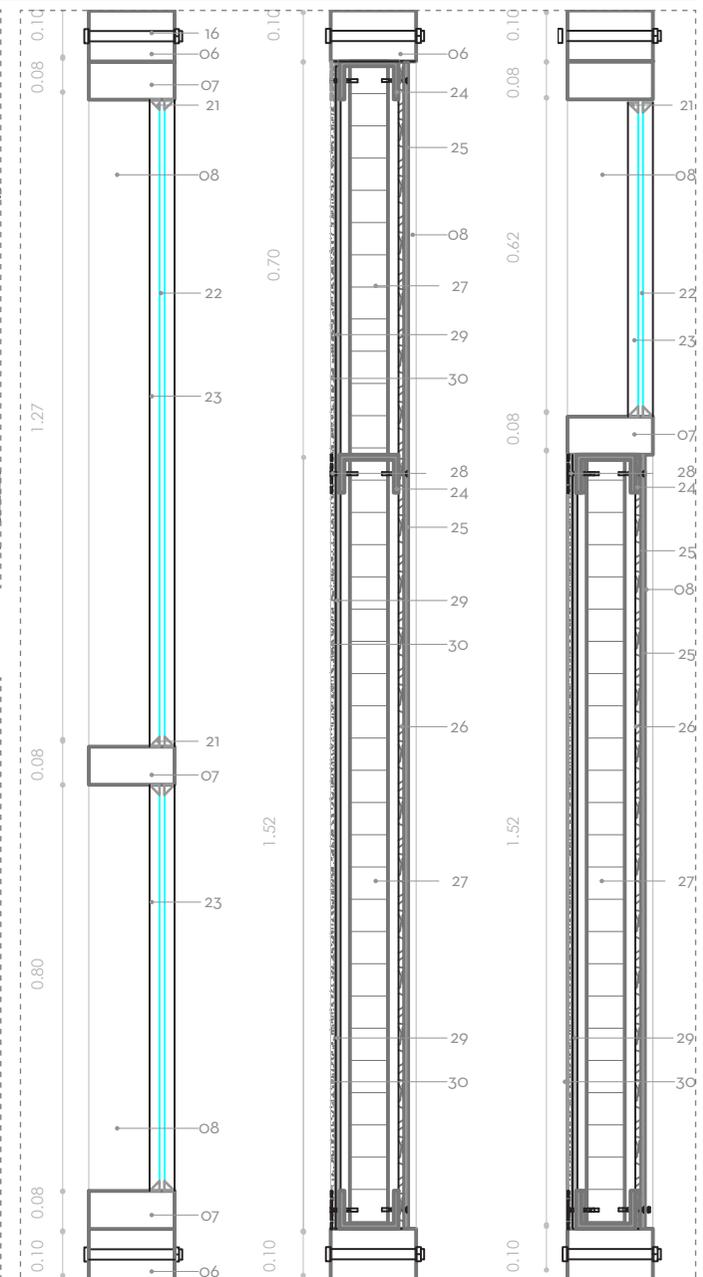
Det_02. Izquierda: Detalle constructivo de panel ventana. Centro: Detalle constructivo de panel ciego. Derecha: Detalle constructivo de panel de baño. Fuente: Los autores Escala: 1,15
